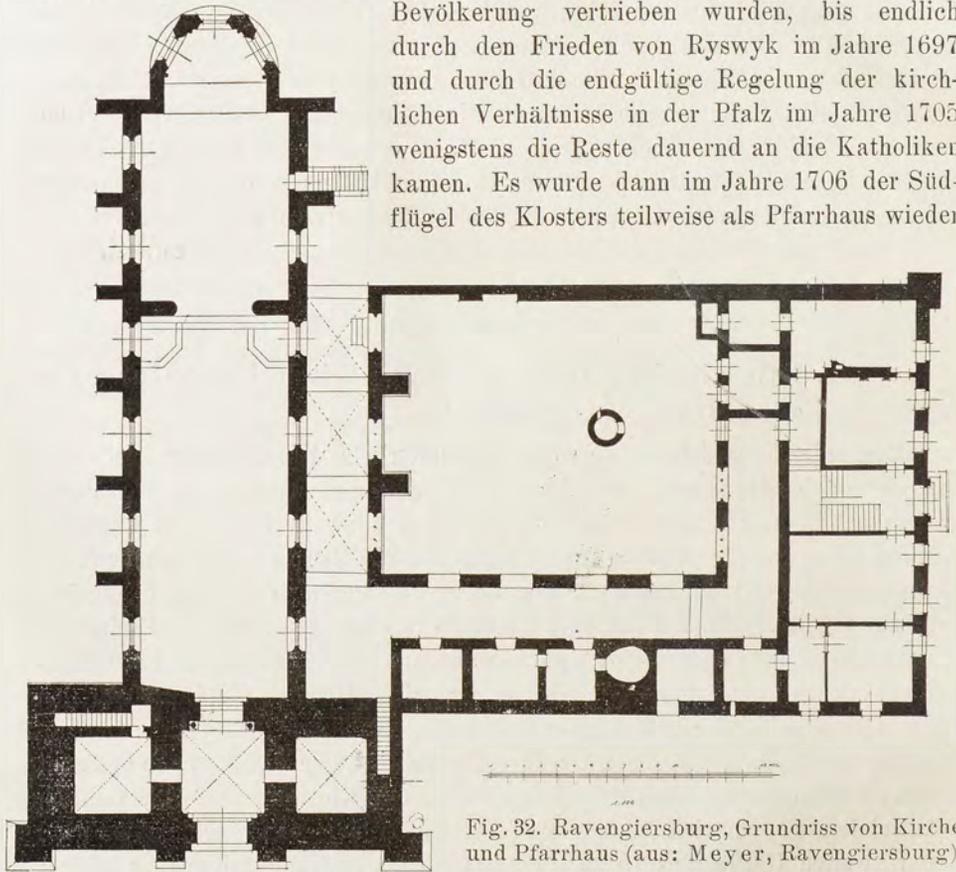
Ravengiersburg, Grundriss von Kirche und Pfarrhaus (aus: Meyer, Ravengiersburg).
